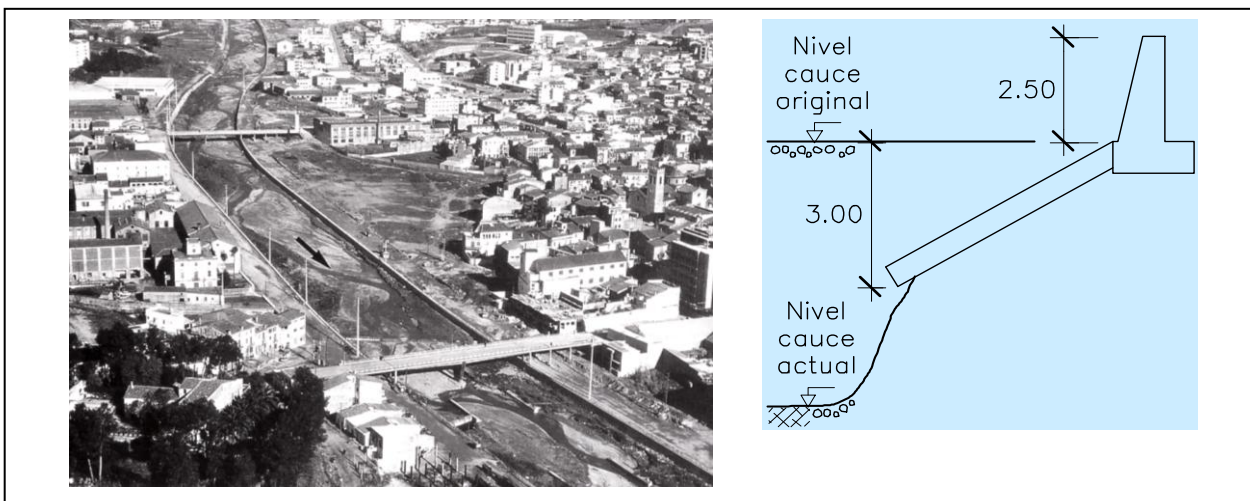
a) izquierda: foto a vista de pájaro de la riera en Rubí algo después de la avenida de 1962, con los muros de la canalización recién construidos tras el movimiento de tierras y el puente superior reconstruido. Las áreas arrasadas, sobre todo en la margen izquierda, se pueden comparar con la Figura 5a. Foto tomada de Xavier Latorre, “Història de l’Aigua a Catalunya”. b) derecha: incisión de la riera de Rubí hacia el año 2000 (5). El muro de la foto a vista de pájaro es el mismo del esquema, de 2.50 m; el resto, de 3.0 m, fue añadido en vista del proceso de incisión que amenazaba al muro. No obstante un tramo de muro se desplomó por la erosión en 1994.
